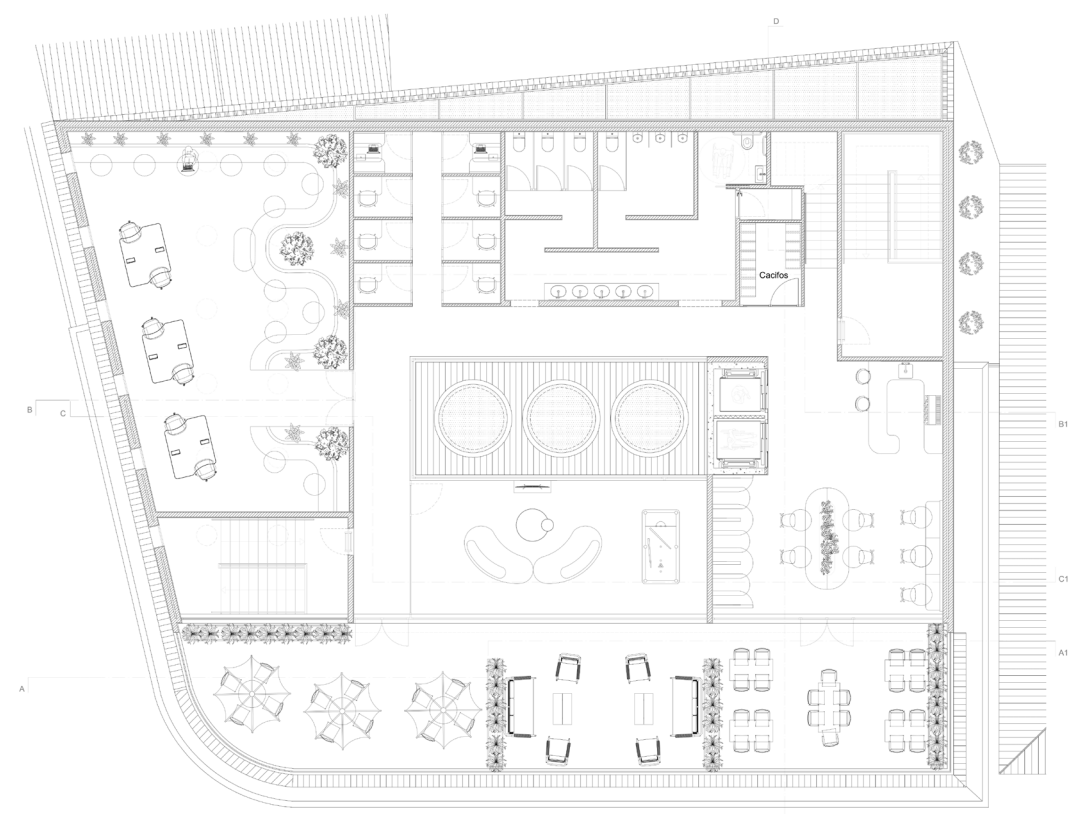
Planta de apresentação do Segundo Piso. Fonte: Autora, em autocad
